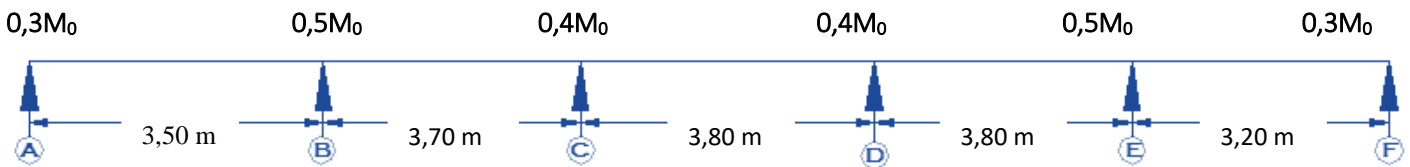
Schéma statique de la poutre à 6 appuis.
